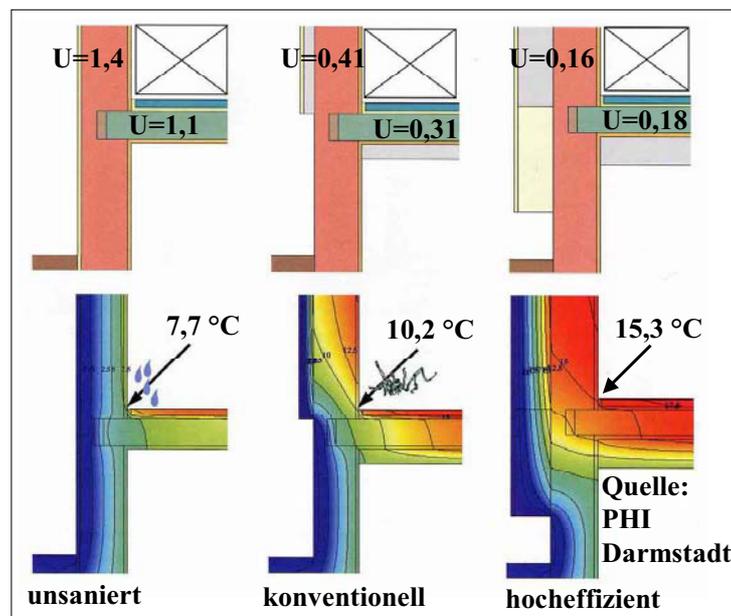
Wärmebrücke im Sockelbereich Keller-Erdgeschoss: unsanierte Variante mit Tauwasserausfall, konventionelle Variante mit Schimmelpilzbefall, hocheffiziente Variante schadensfrei [PHI 2003-2]
